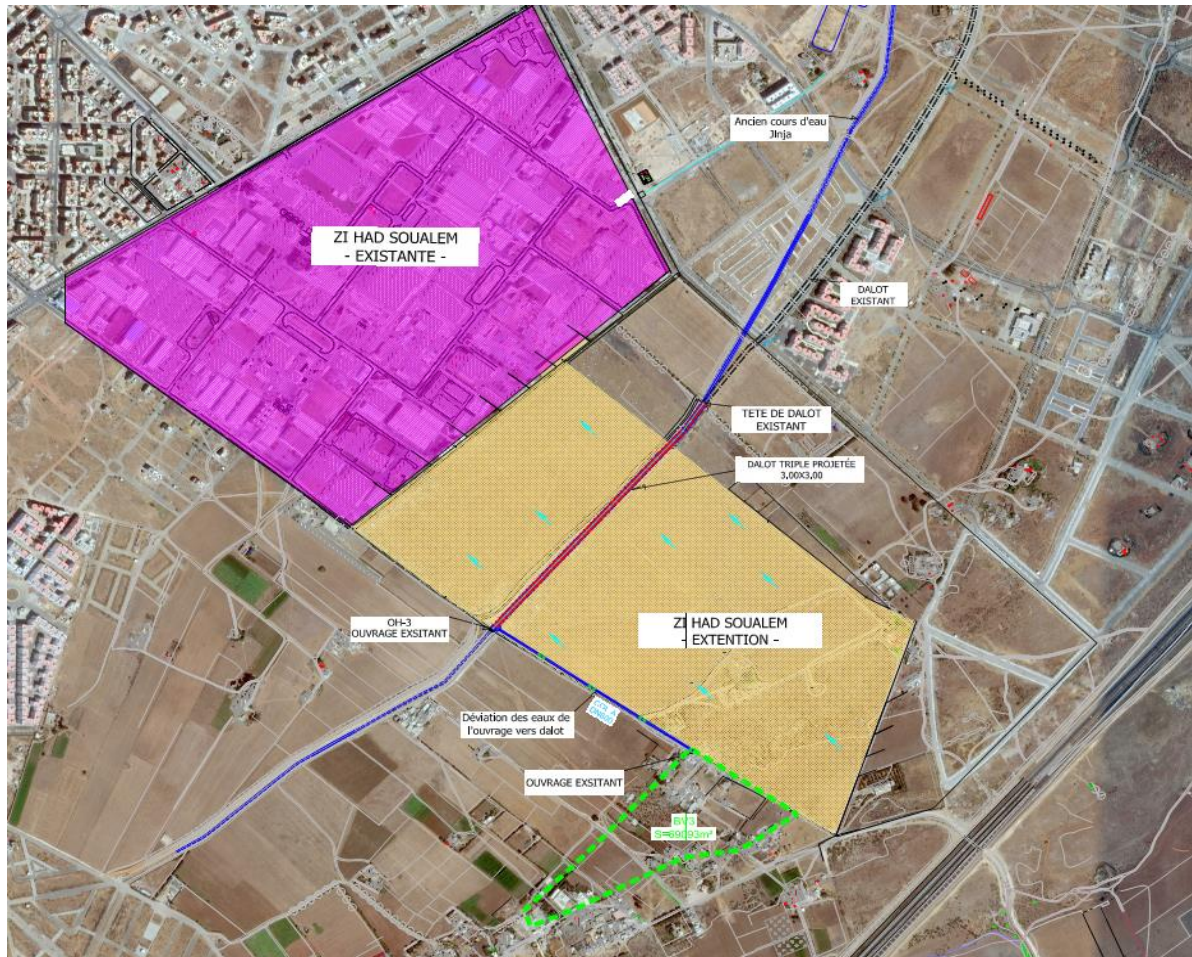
Traversée du site par l'oued Jinja– Extension de la ZI Had Soualem.
